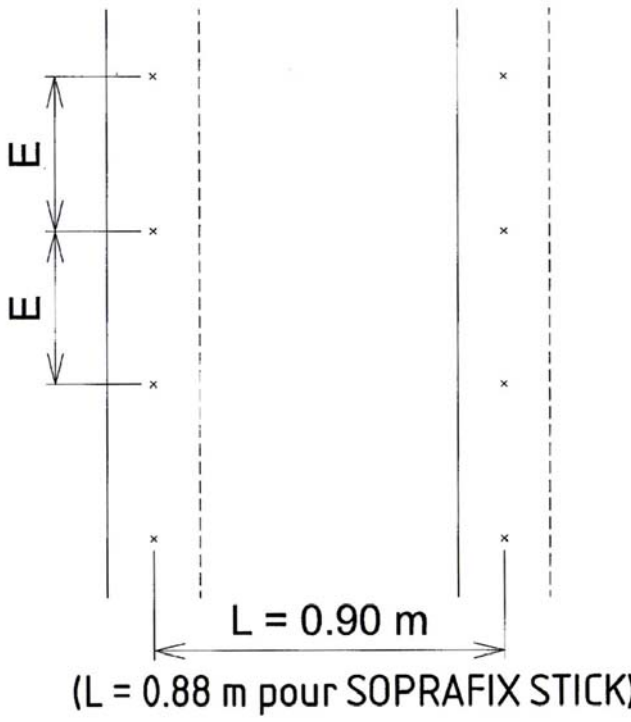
Disposition courante des fixations dans le recouvrement longitudinal
